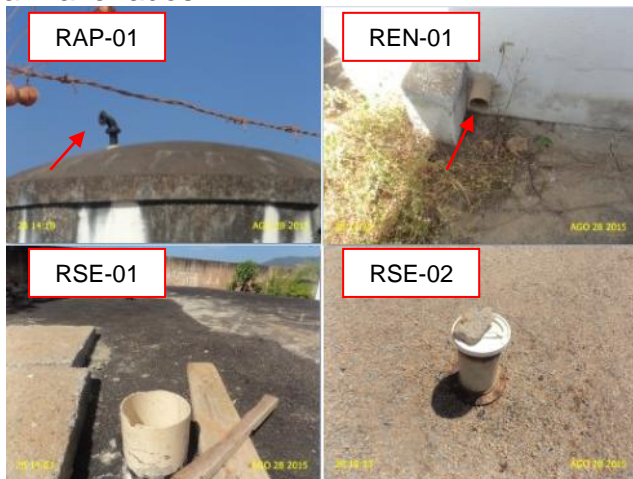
RAP-01, REN-02, RSE-02 e RSE-03: tubulação de ventilação sem tela de proteção.
